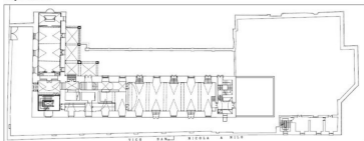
Planimetria del complesso dell'ex Asilo Filangieri
